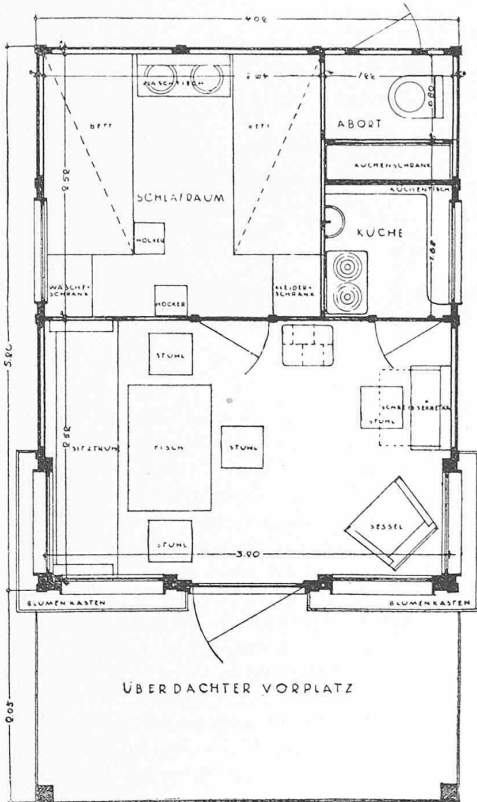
Grundriss zu Abbildung 3. — Masstab 1 : 50.
